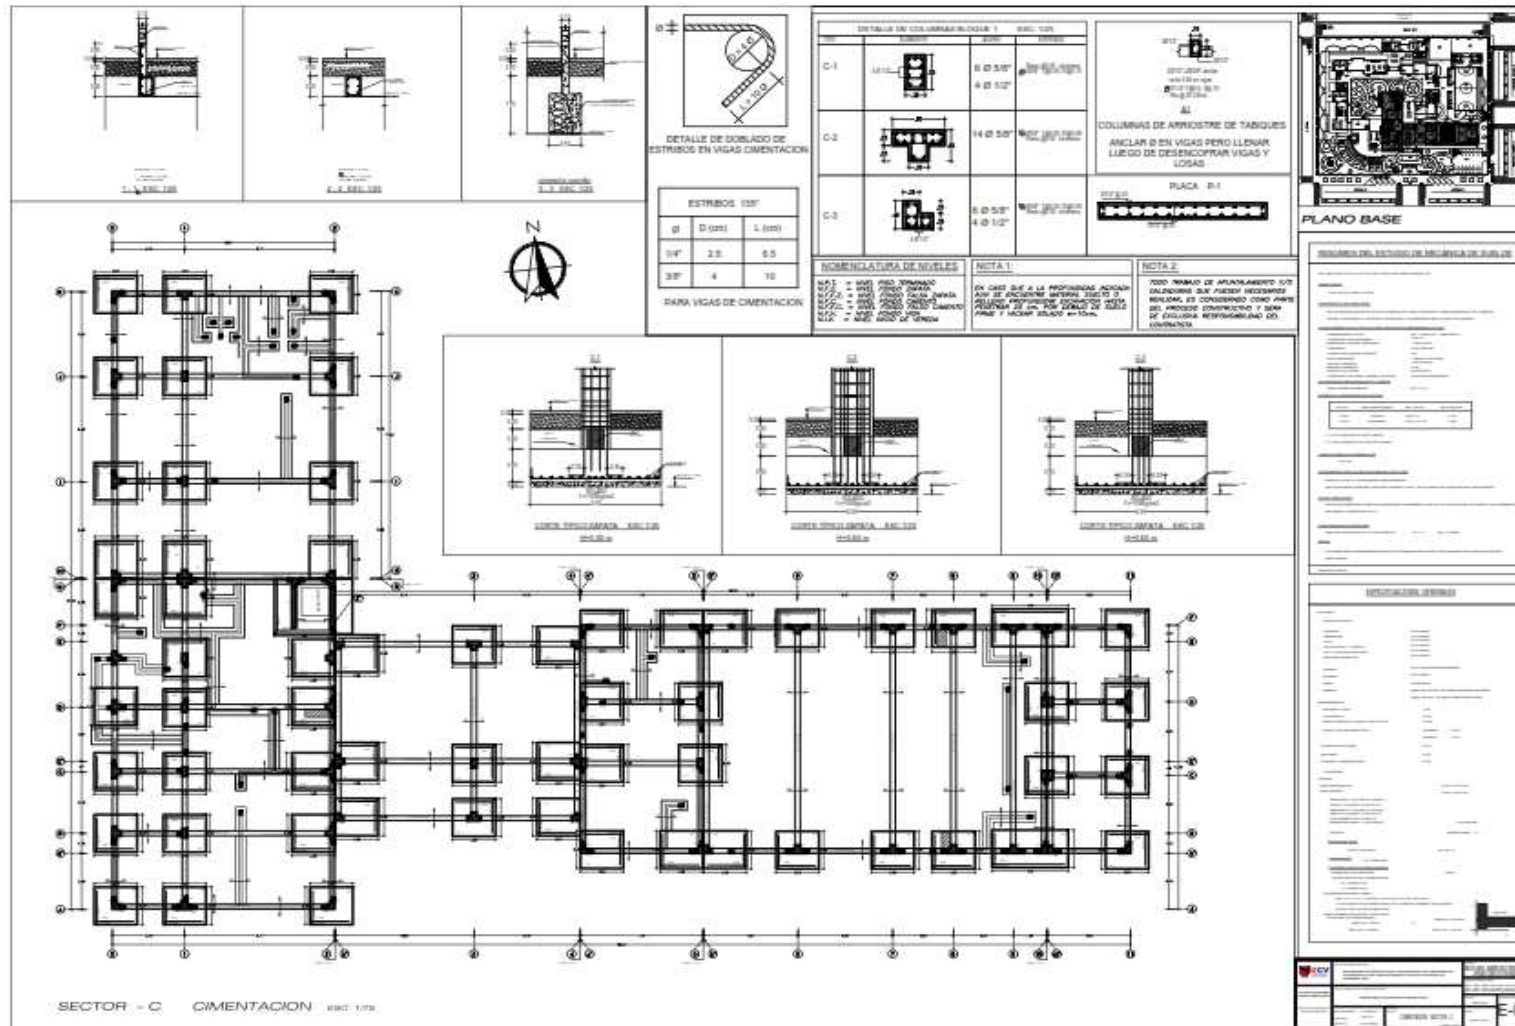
Plano diseño estructural bloque complementarios cimientos – Lamina E-03
